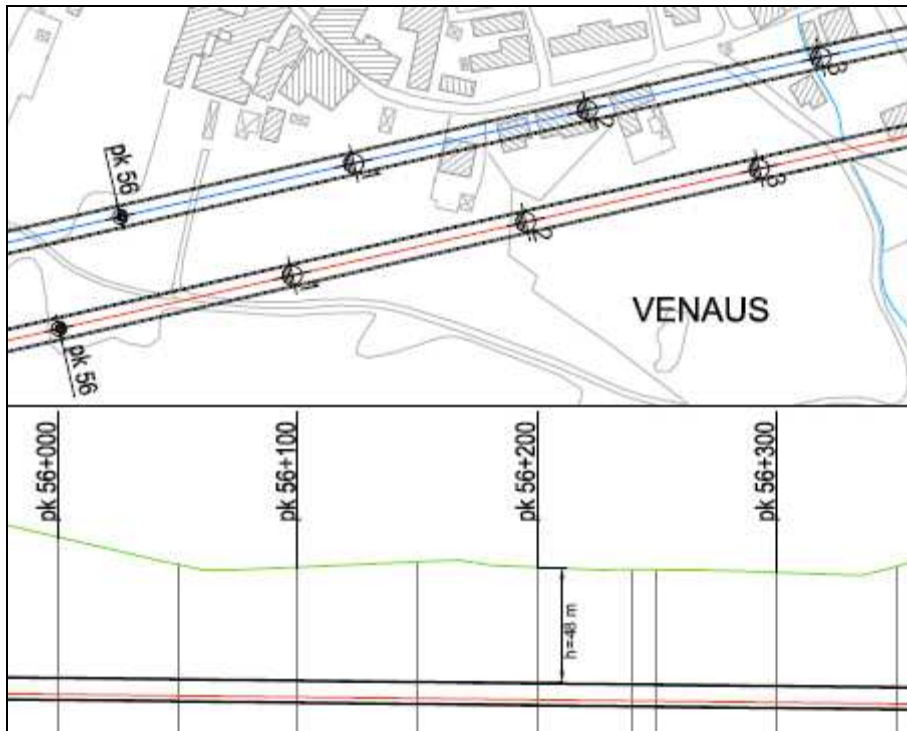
Tunnel di Base - Stralcio Sottoattraversamento Venaus - Planimetria + Profili
